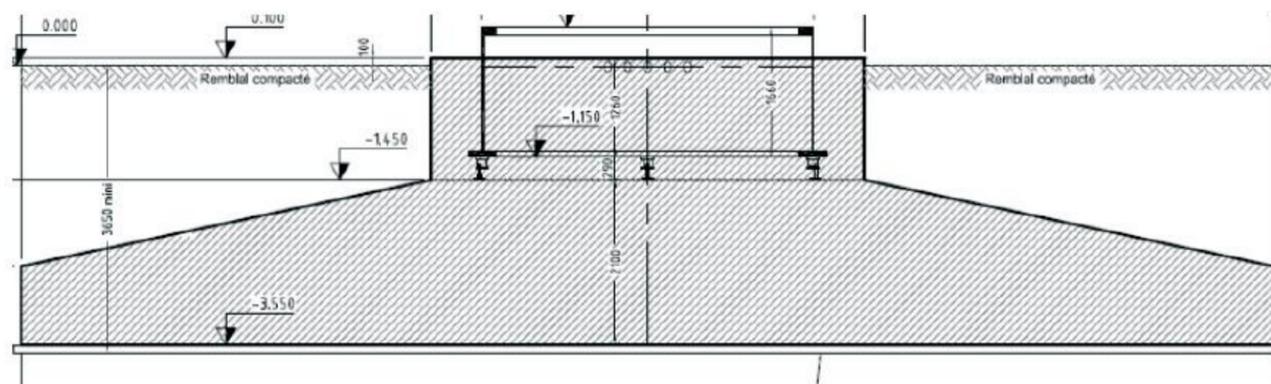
Fondation d'éolienne (Source – Brise Picarde)
